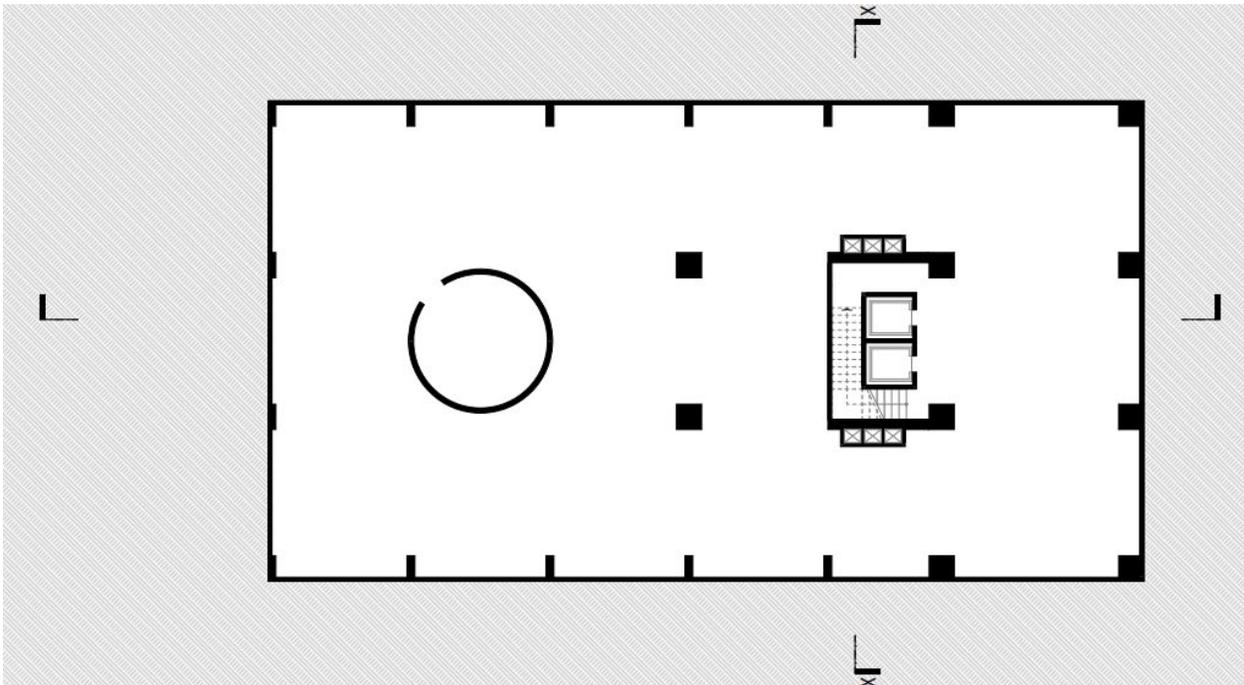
Planta original de subsuelo N -3. Fuente Tesistas.
